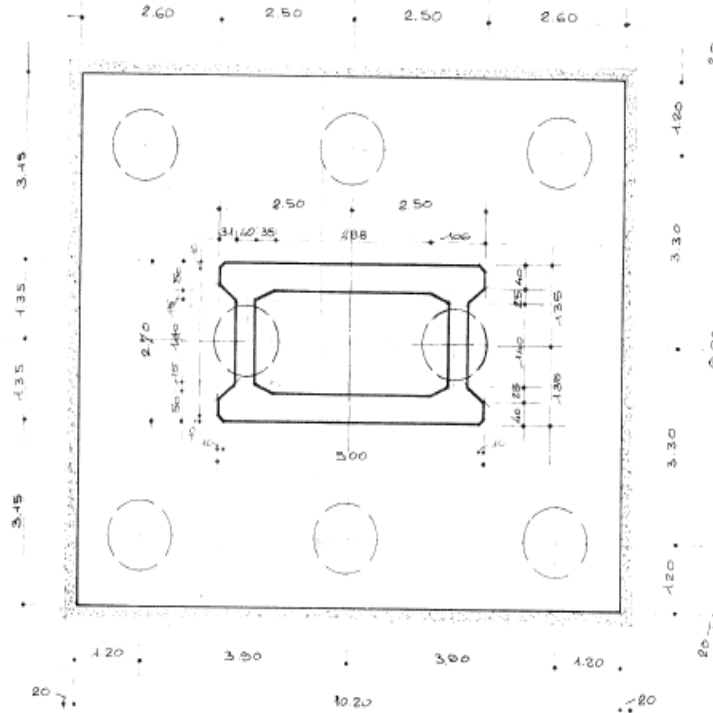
Pianta della fondazione con indicazione dei pali, 8 pali
